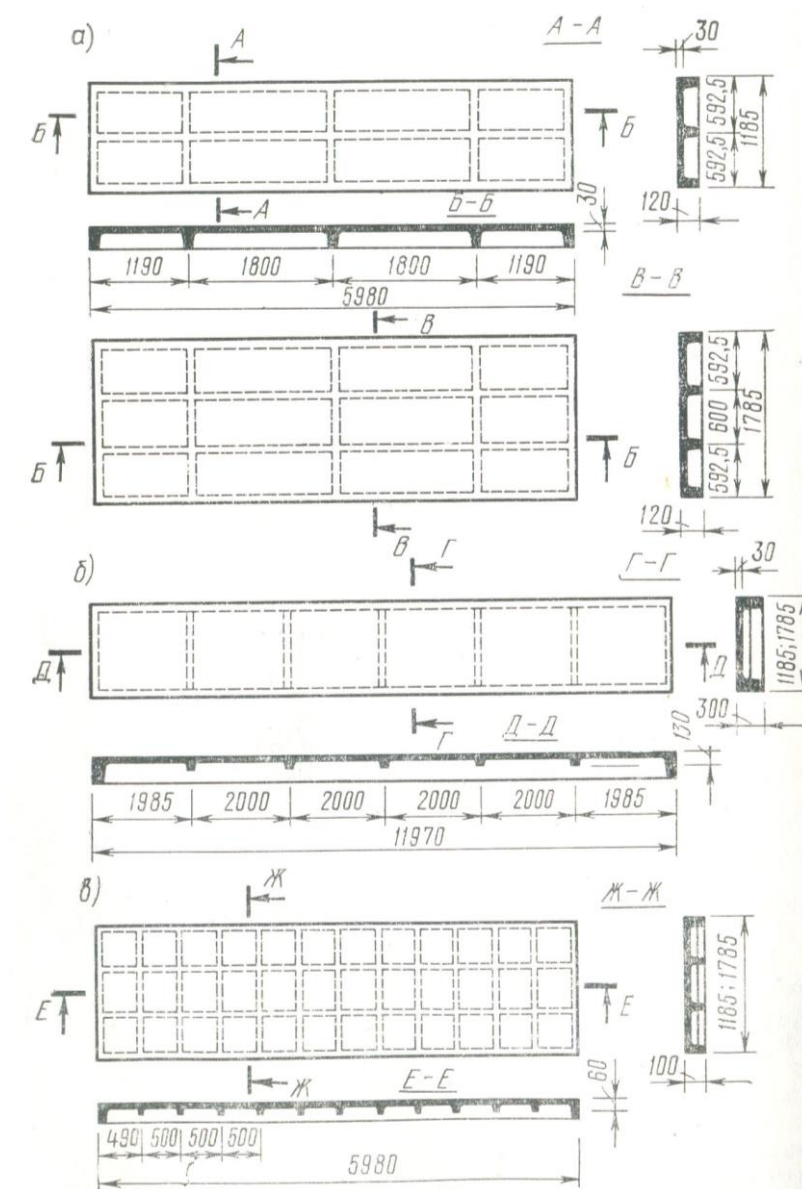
Залізобетонні панелі для стін неопалювальних будівель
